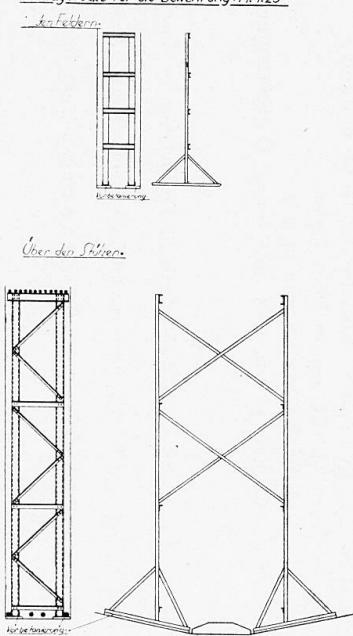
Chevalets de montage pour les armatures = Montageböcke für die Bewehrung = Scaffolding for erecting reinforcement.
